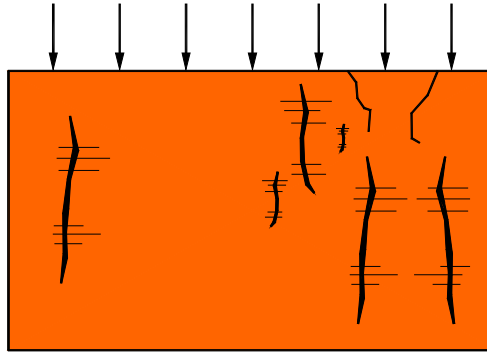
Fissuração típica da alvenaria causada pela actuação excessiva de cargas [30]
